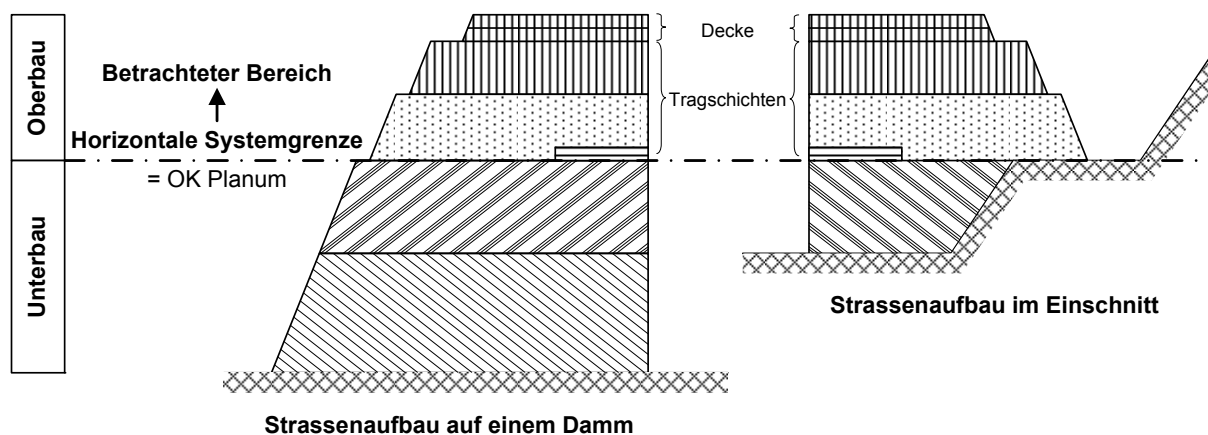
Strassenaufbau nach SN 640302b (SN 640302b 2000) – Horizontale Systemabgrenzung
